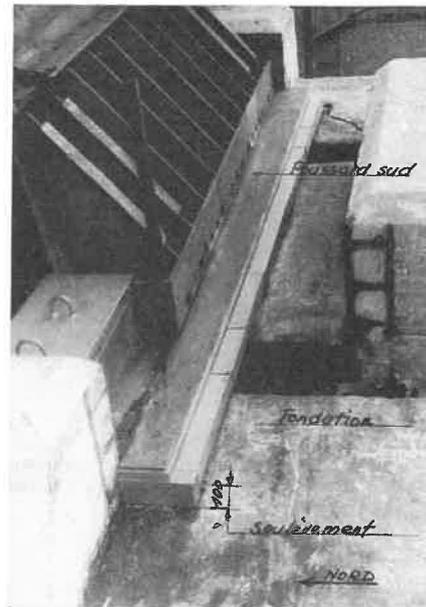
Vue des épaisseurs (100 mm) placées sous le pied du poussard sud.
